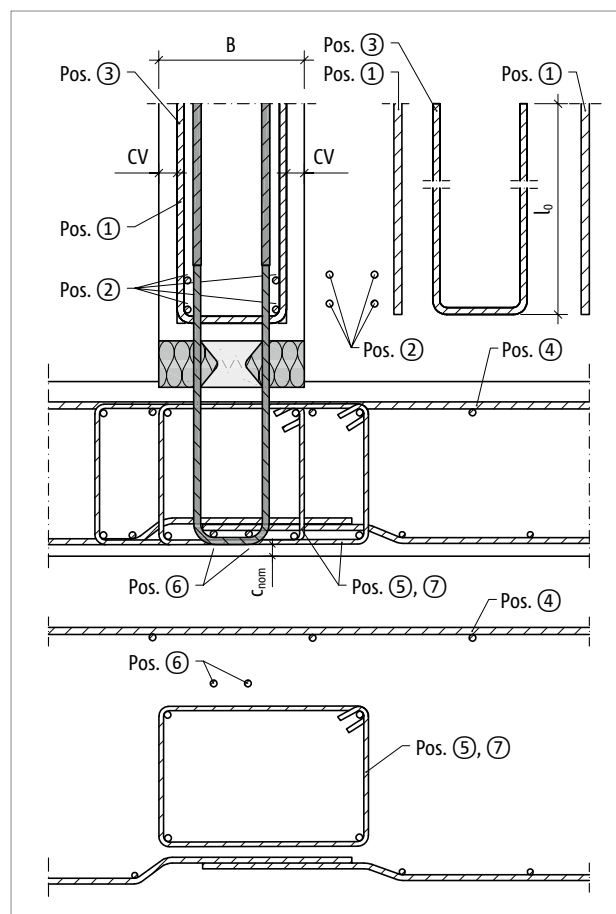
Schöck Sconnex® type W-NT-B: Bijlegwapening bij trekkrachtverankering in de vloerplaat met bijlegwapening pos. 5
